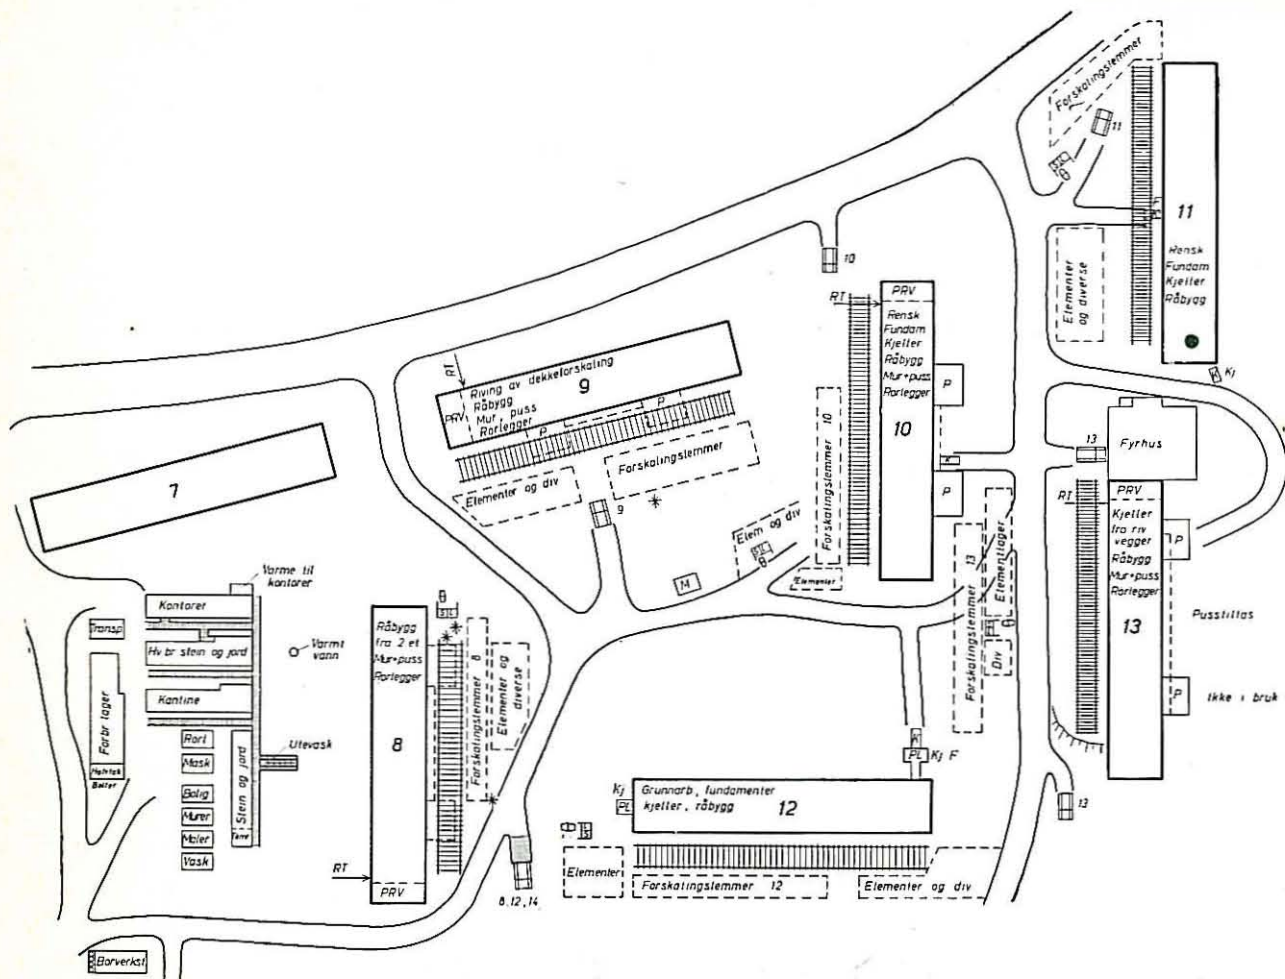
Plan som viser tilrigging på endel av byggeplassen.
